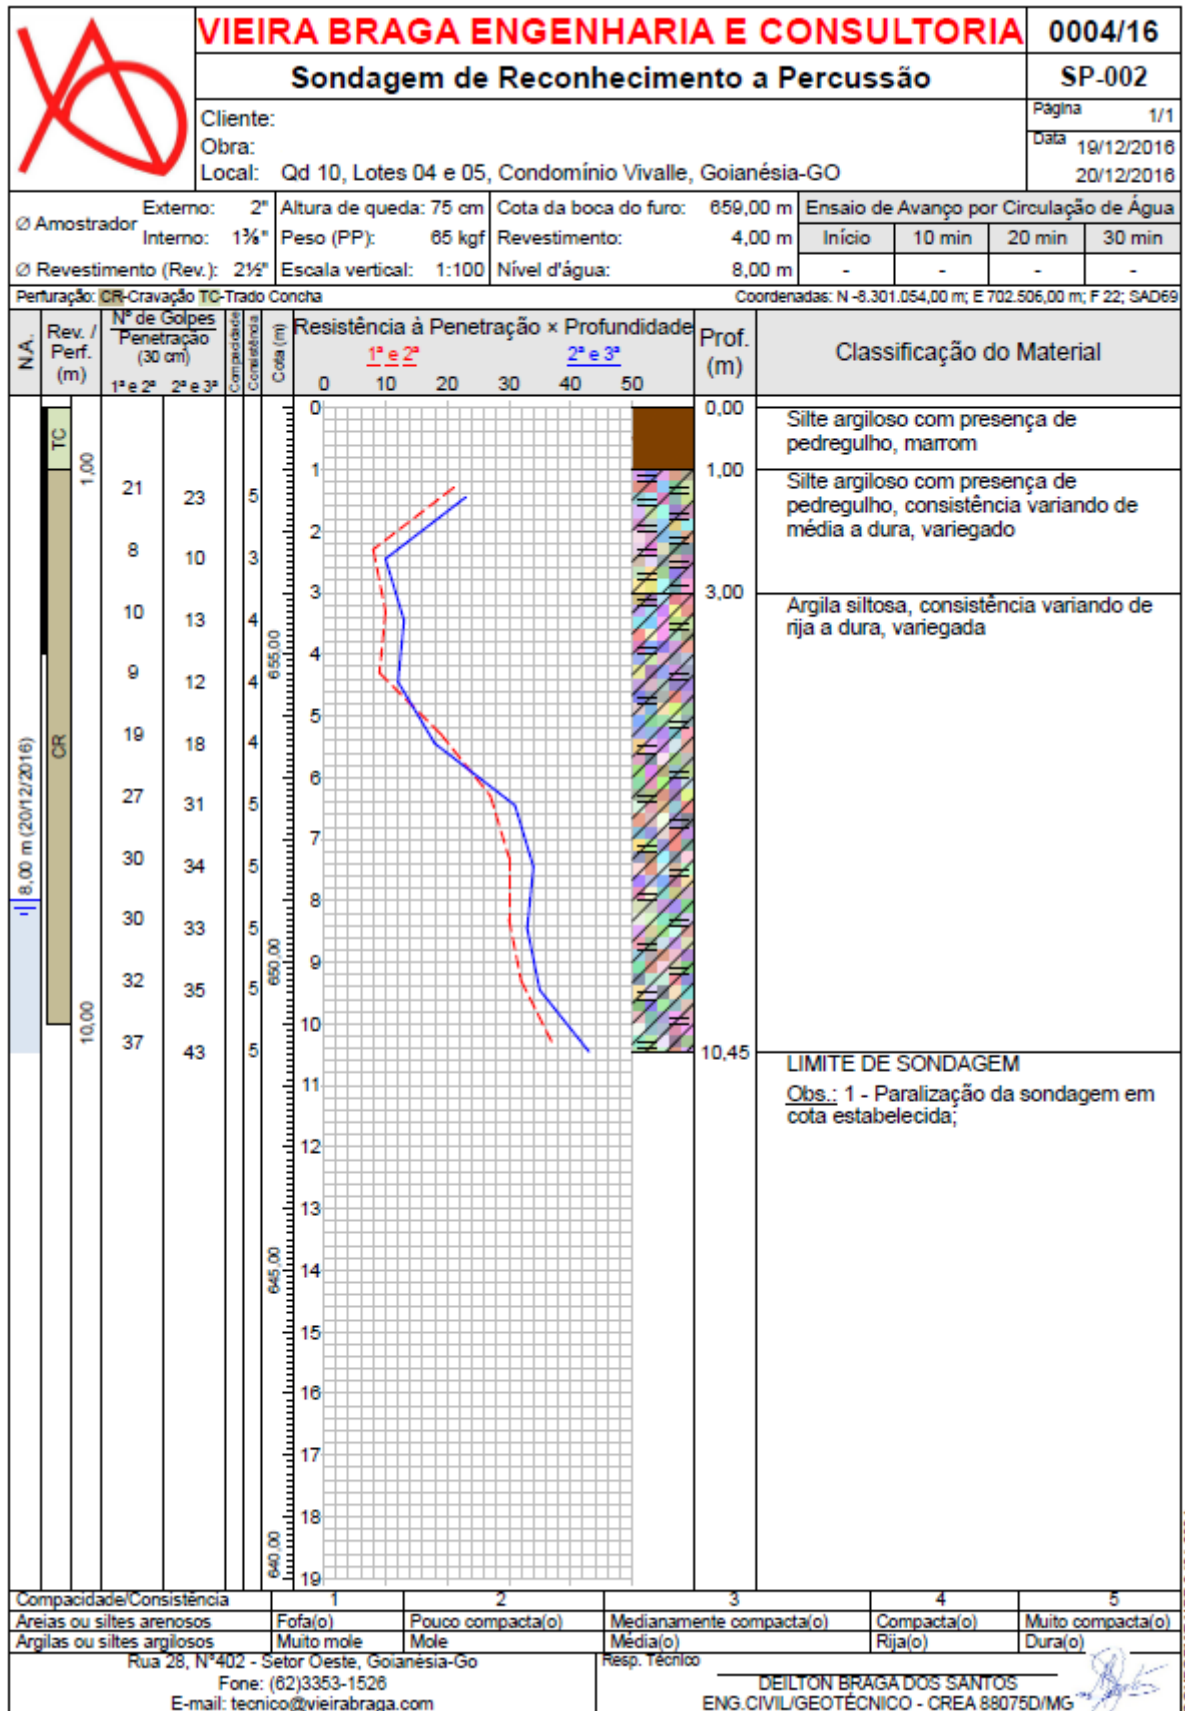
Laudo 03 – SPT/standard penetration test – Fonte: Vieira Braga Engenharia e Consultoria
